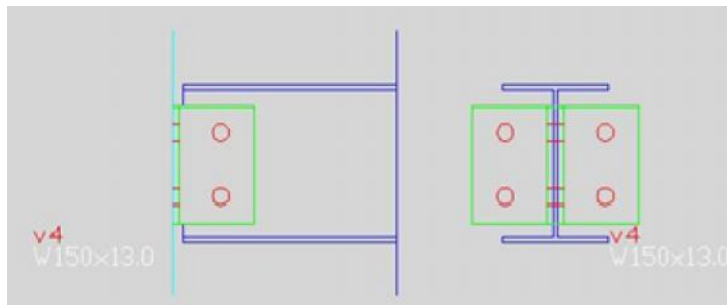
Ligação Metálica com duas cantoneiras parafusadas nas duas abas (LCPP) inserida em projeto de arquitetura.
